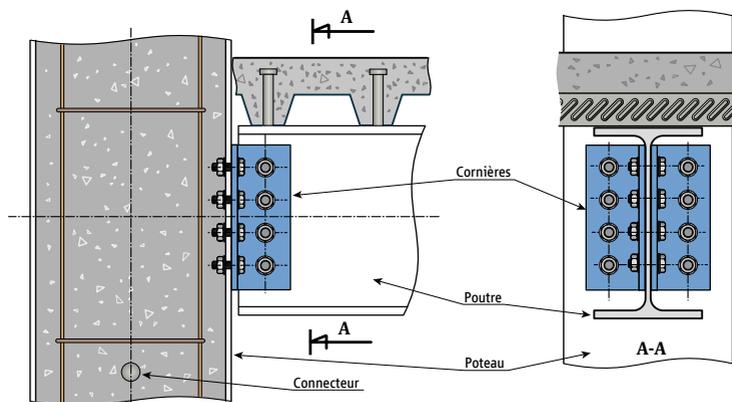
Assemblage articulé par double cornière sur poteau mixte
